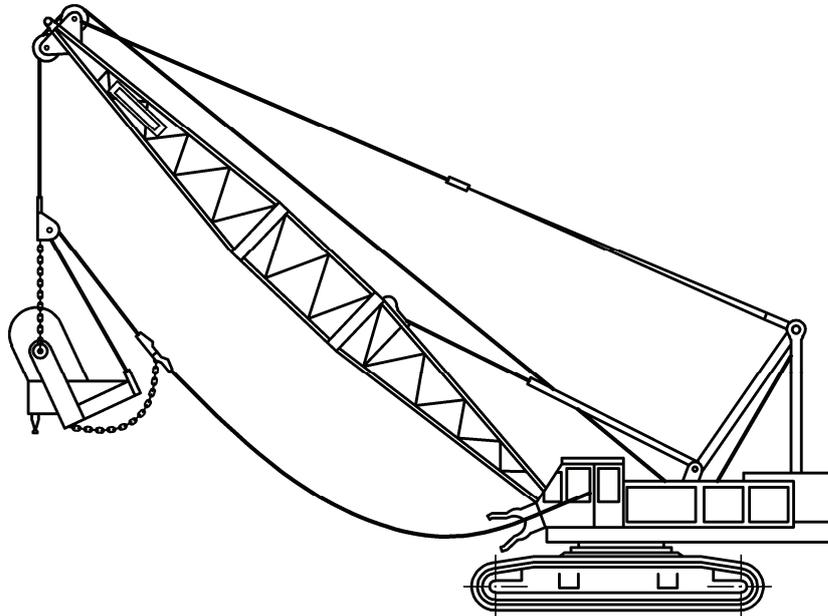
Seilbagger auf Kettenlaufwerk mit Schürfkübelausrüstung
